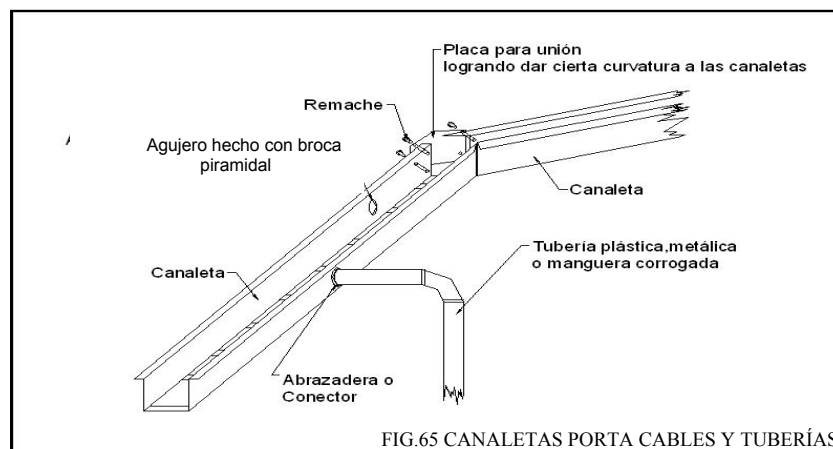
CANALETAS PORTA CABLES Y TUBERÍAS
